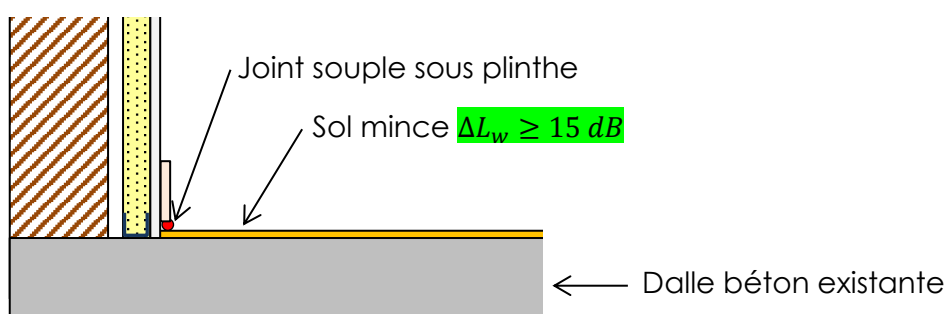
Schéma de principe en coupe – Plancher créé bâtiment 1963
